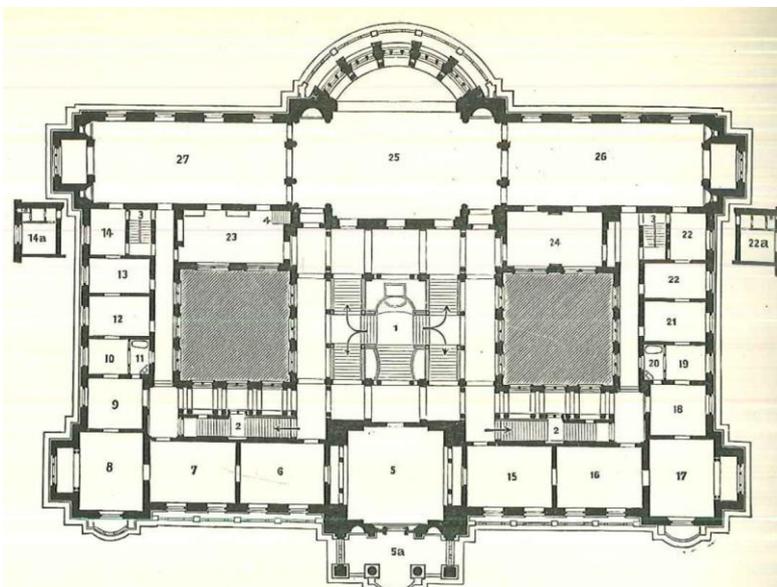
Kaiserpalast. Grundriss vom Hauptgeschoss, aus dem Centralblatt der Bauverwaltung
